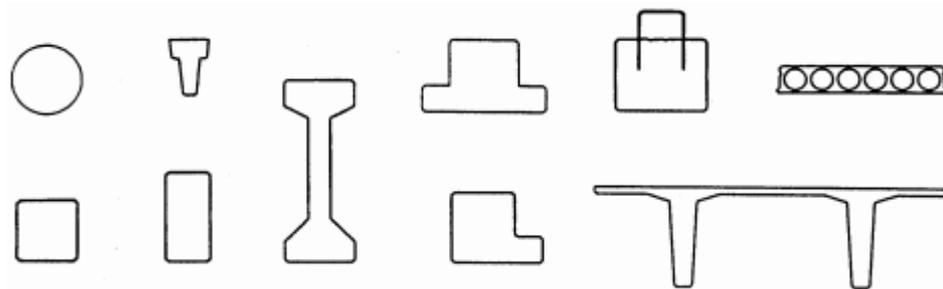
Exemplos de seções transversais para peças de concreto pré-moldado
